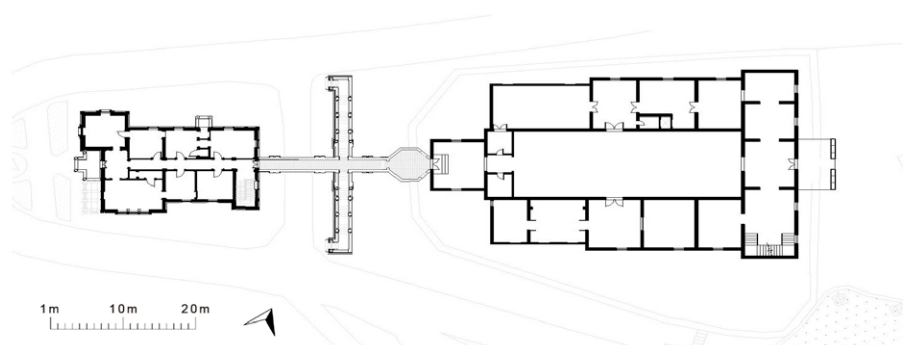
| Plantas do 2º pavimento da Villa Ferreira Lage à esquerda, passagem de ligação e 1º pavimento do edifício Mariano Procópio à direita.
